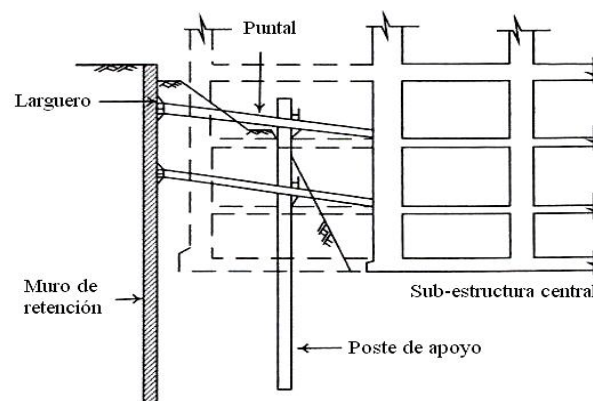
Excavación utilizando la subestructura central como apoyo (Puller, 1996).
